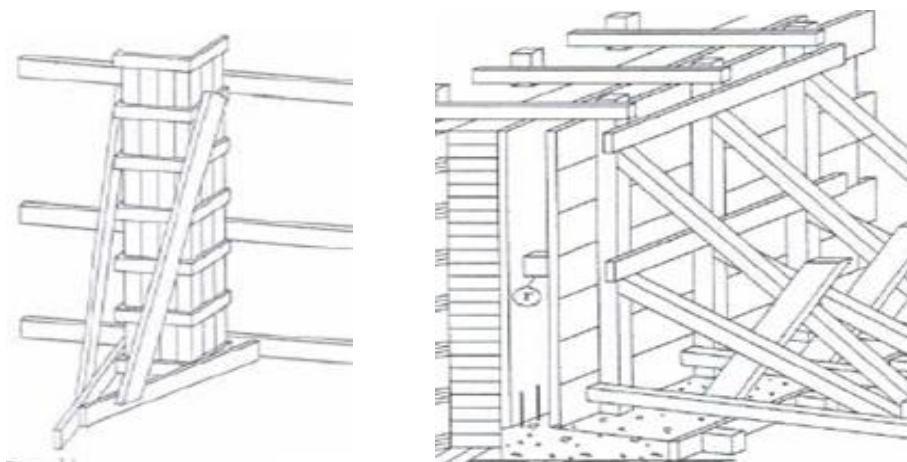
Cofragem de pilar e muro de suporte [7]
